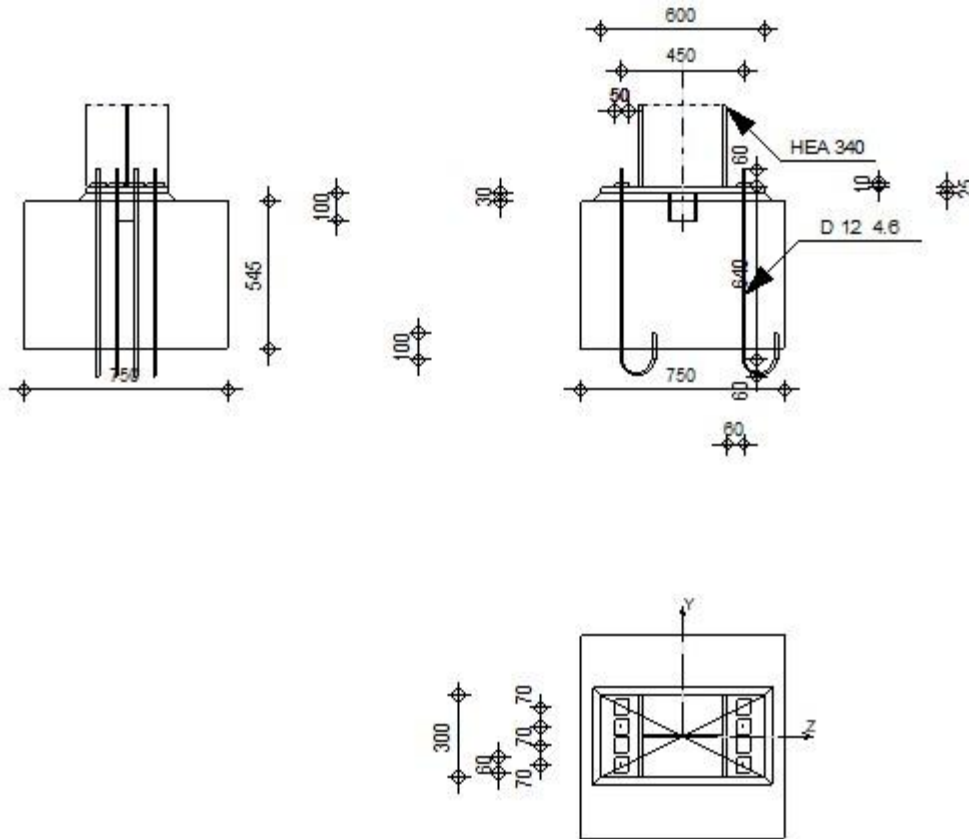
Détail de l'assemblage au niveau de pied de poteau
